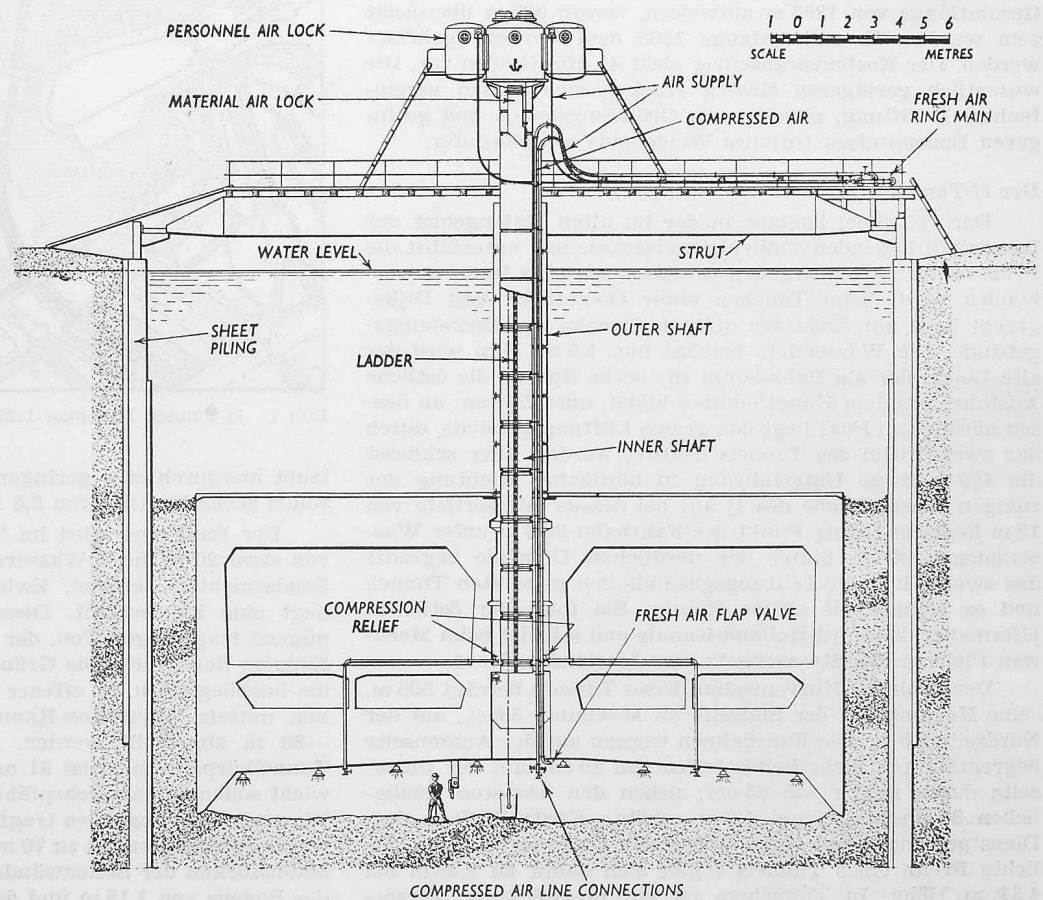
Ij-Tunnel, Bauvorgang, Querschnitt 1:300
